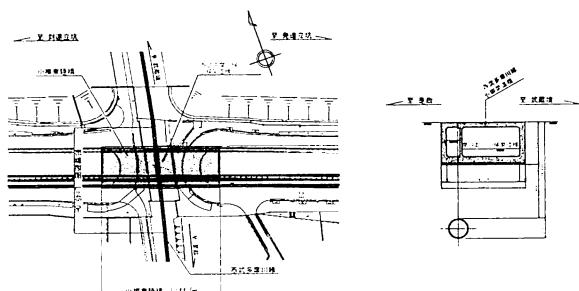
西武多摩川線・小柳架道橋通過部平面・断面図
